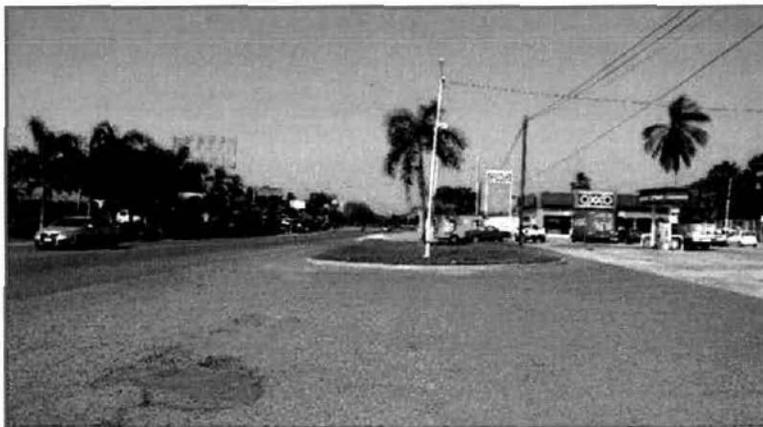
Vista sur de la Estación de Servicio, colindante a la Carretera Nacional
